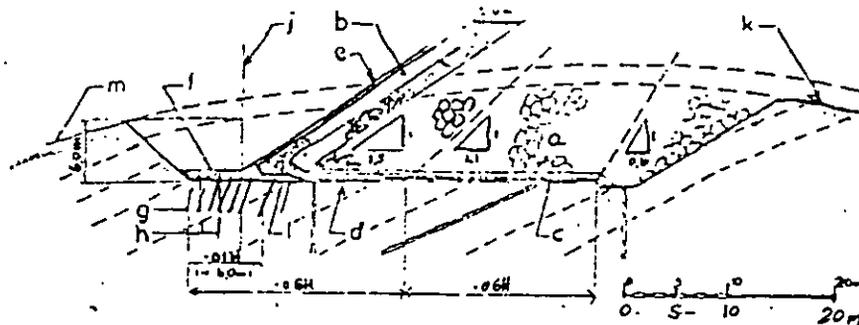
Detalles de la cimentación de la Presa Winneke.
